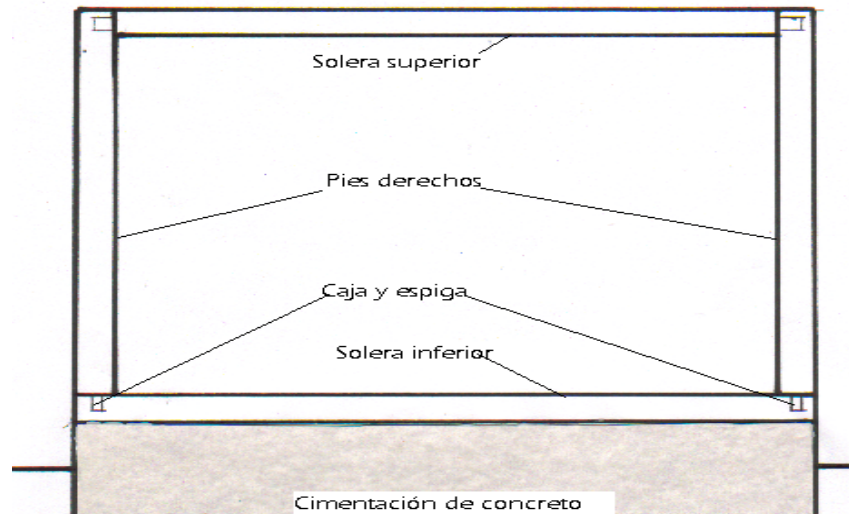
Pórtico de madera maciza sobre cimentación de concreto.
